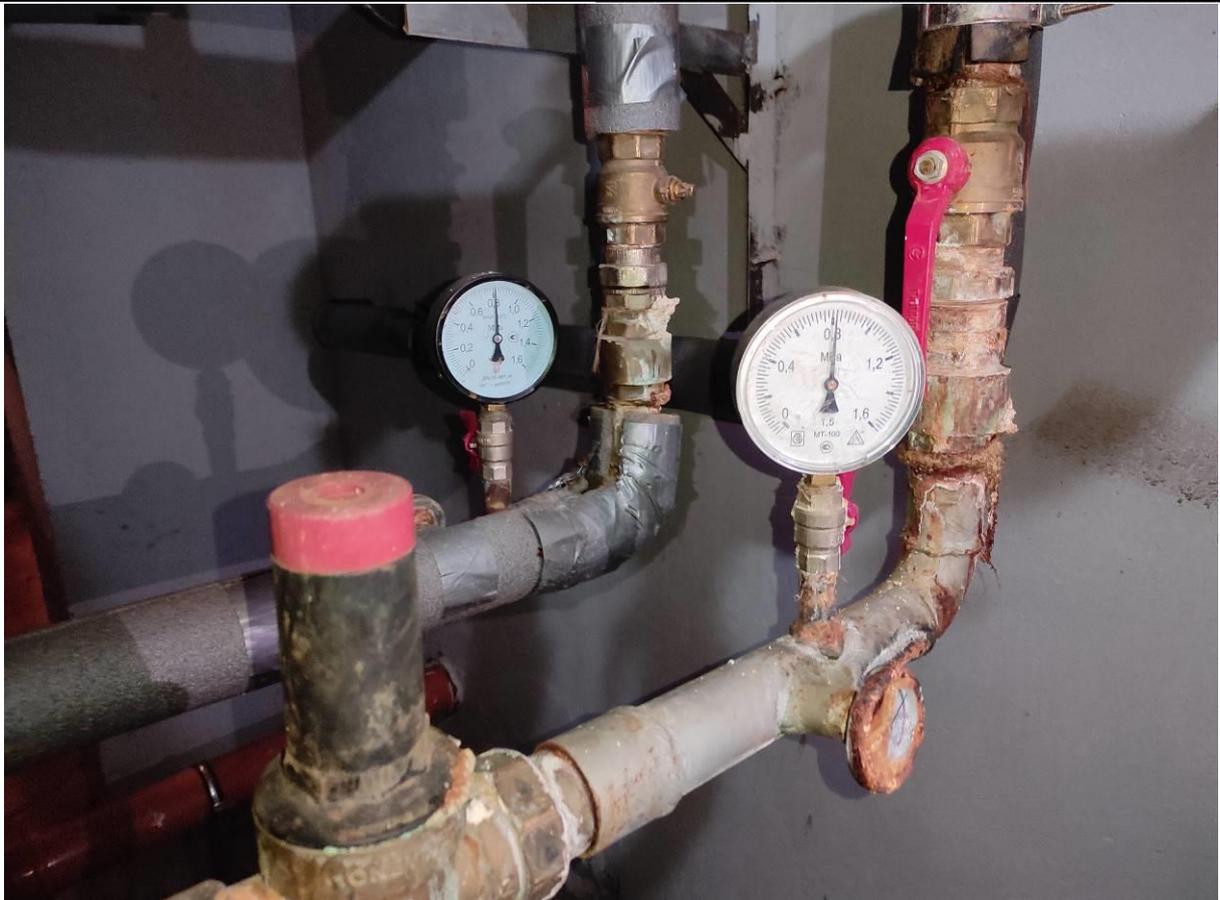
Негерметичное резьбовое соединение запорной арматуры и трубопровода. Следы протечек, коррозия. Частичное отсутствие теплоизоляции на трубопроводах
